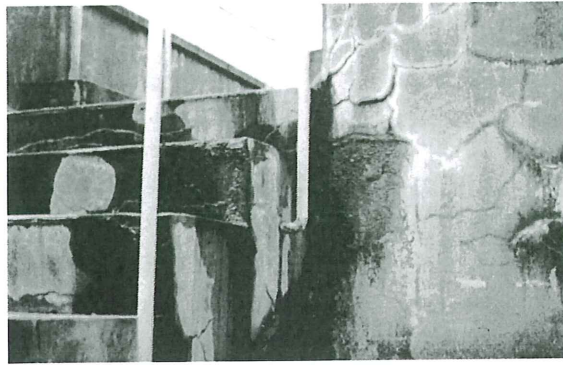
屋外階段モルタル仕上げのひび割れ
